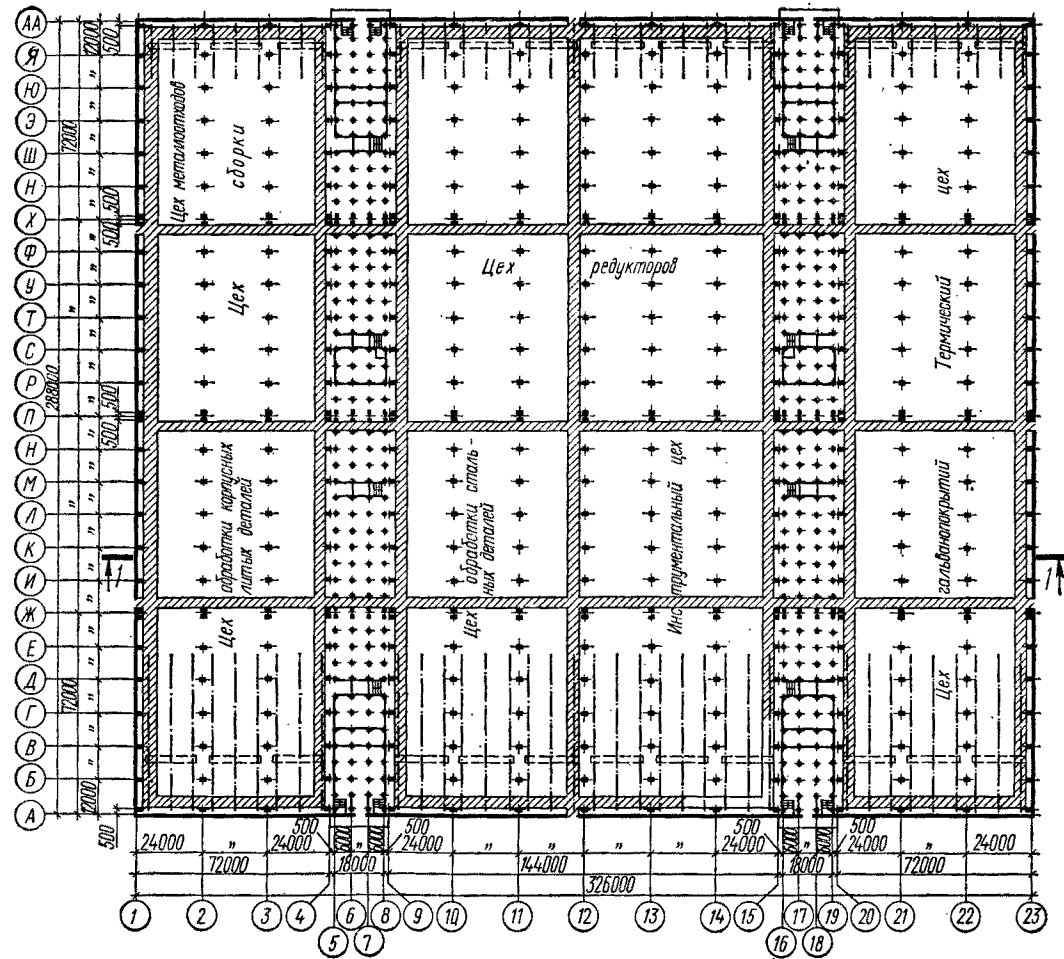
План корпуса № 1 механо-сборочного цеха автозавода в г. Рыбное
